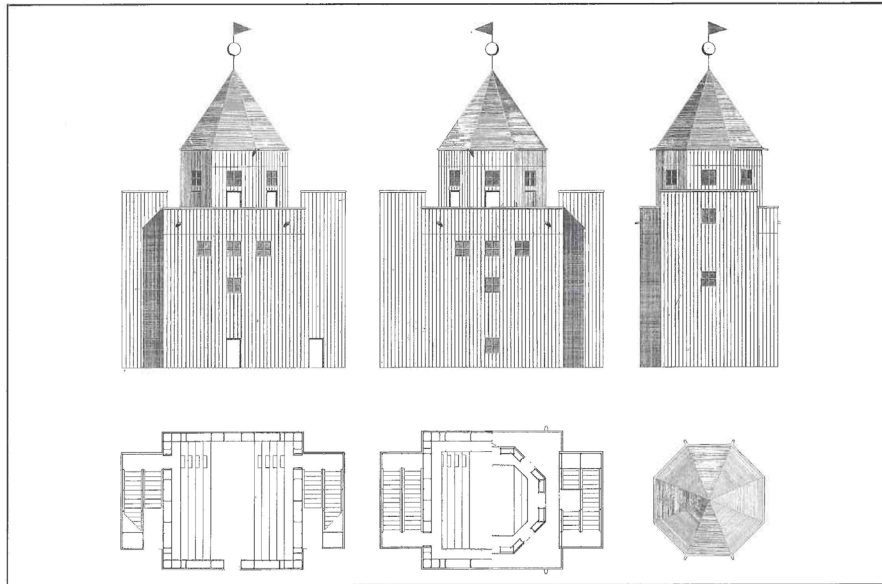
Teatro del Mondo- Grundrisse und Ansichten
